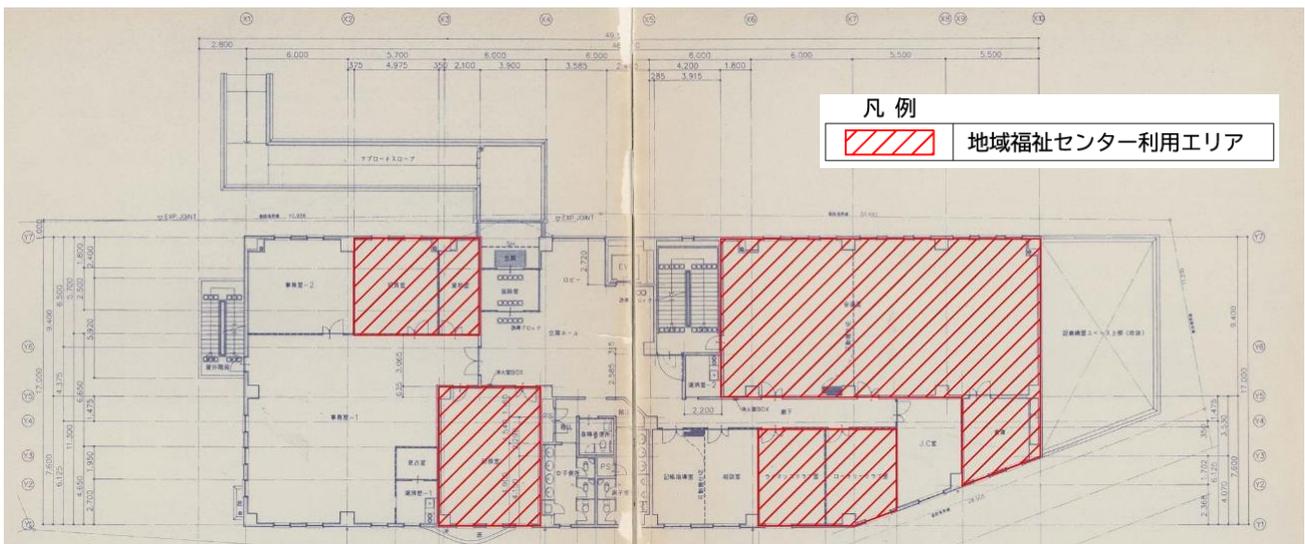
地域福祉センター 機能位置図 (案) 2階平面図
